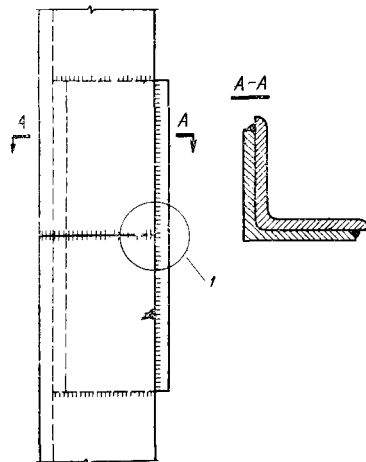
Монтажный стык анкерной угловой опоры:
